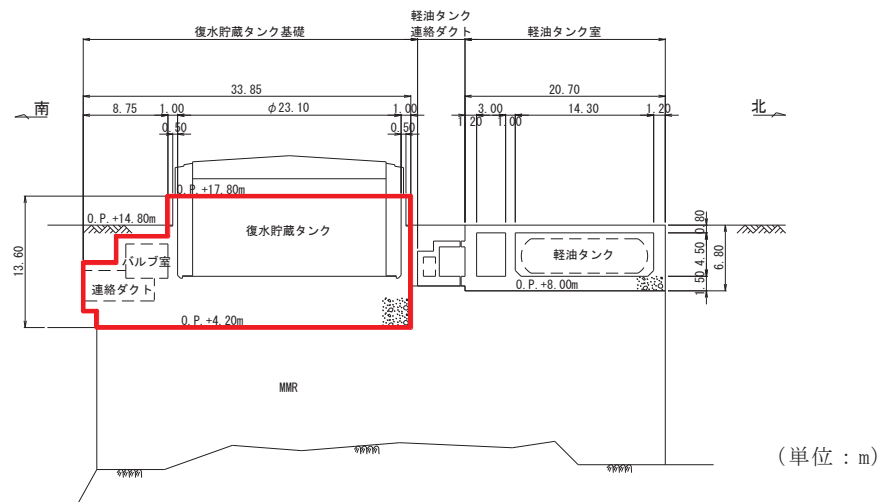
復水貯蔵タンク基礎断面図 (A-A 断面, 南北)
